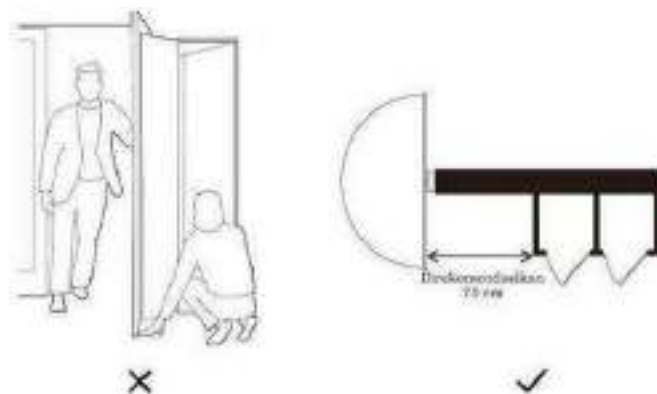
21 Pintu yang berhadapan dengan tangga perlu mengubah
